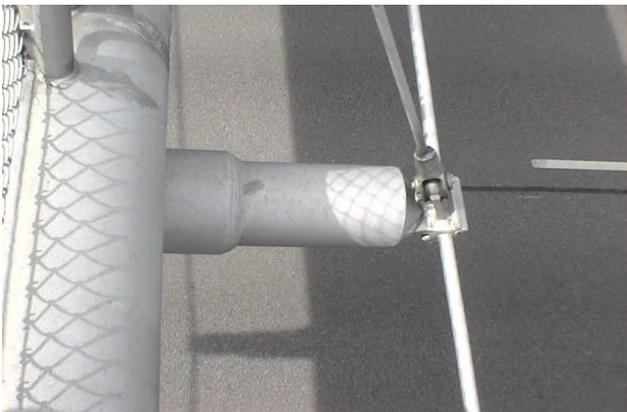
Sistema de anclaje del cable al tablero para puentes de carga ligera.
